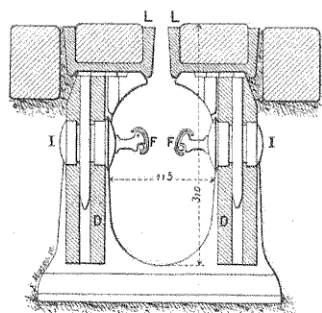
Coupe du caniveau primitif de Blackpool.
